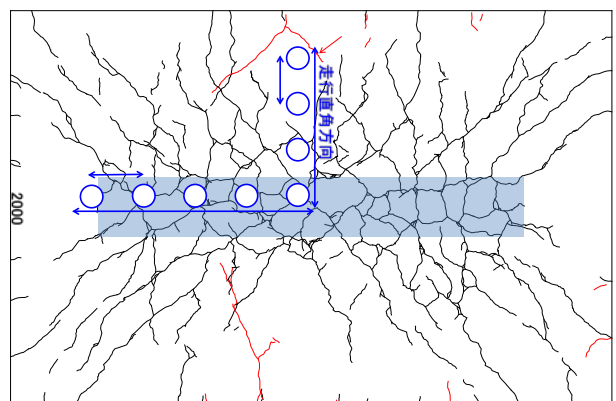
輪荷重走行試験終了時のひび割れ状況
